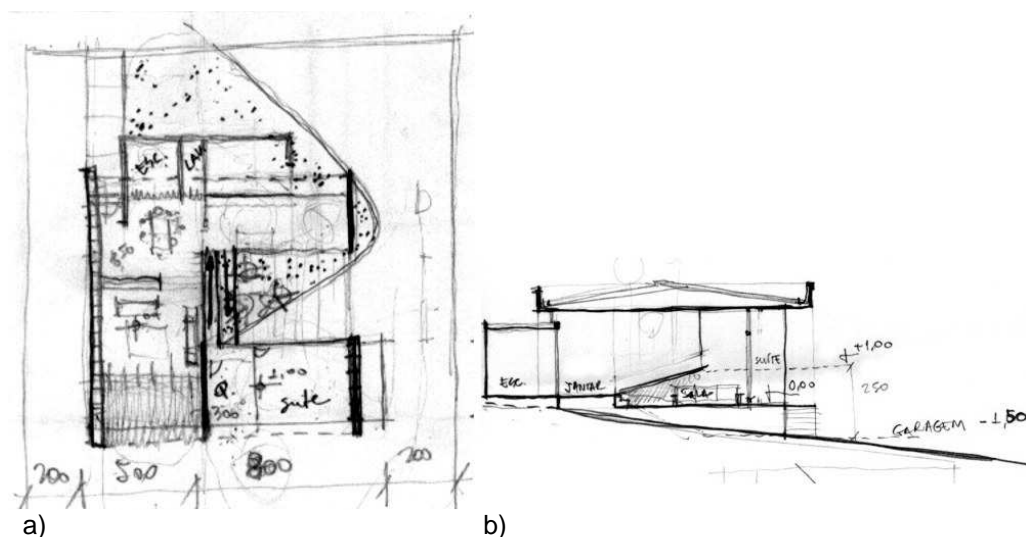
a) planta e b) corte de proposta com desníveis entre salas e pergolado a W
